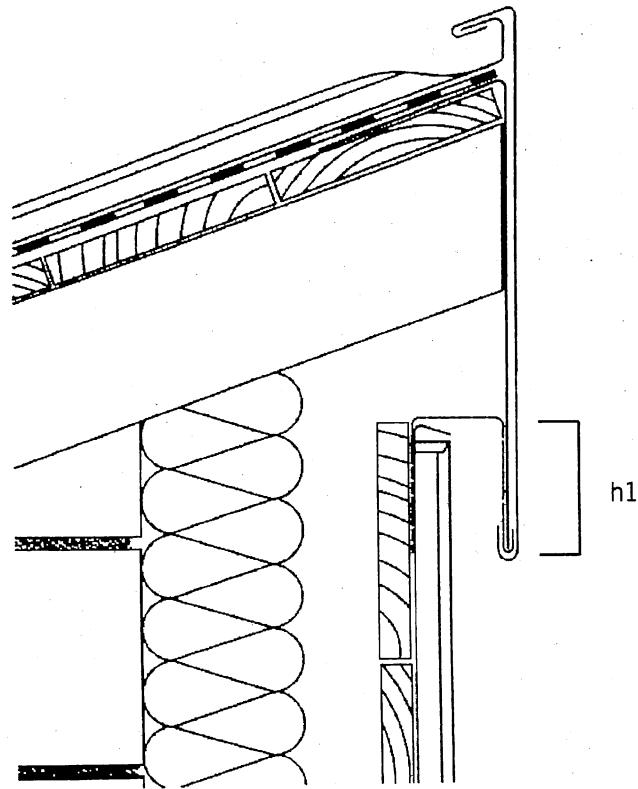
Oberer Fassadenabschluss mit Entlüftung
